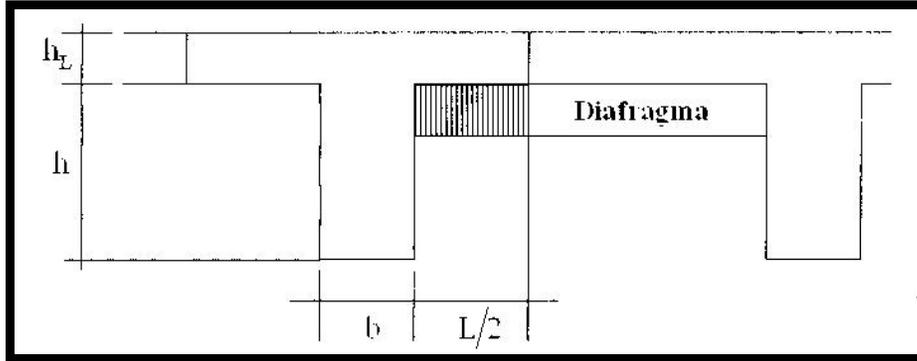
Porción de diafragma considerada en el análisis de viga externa
